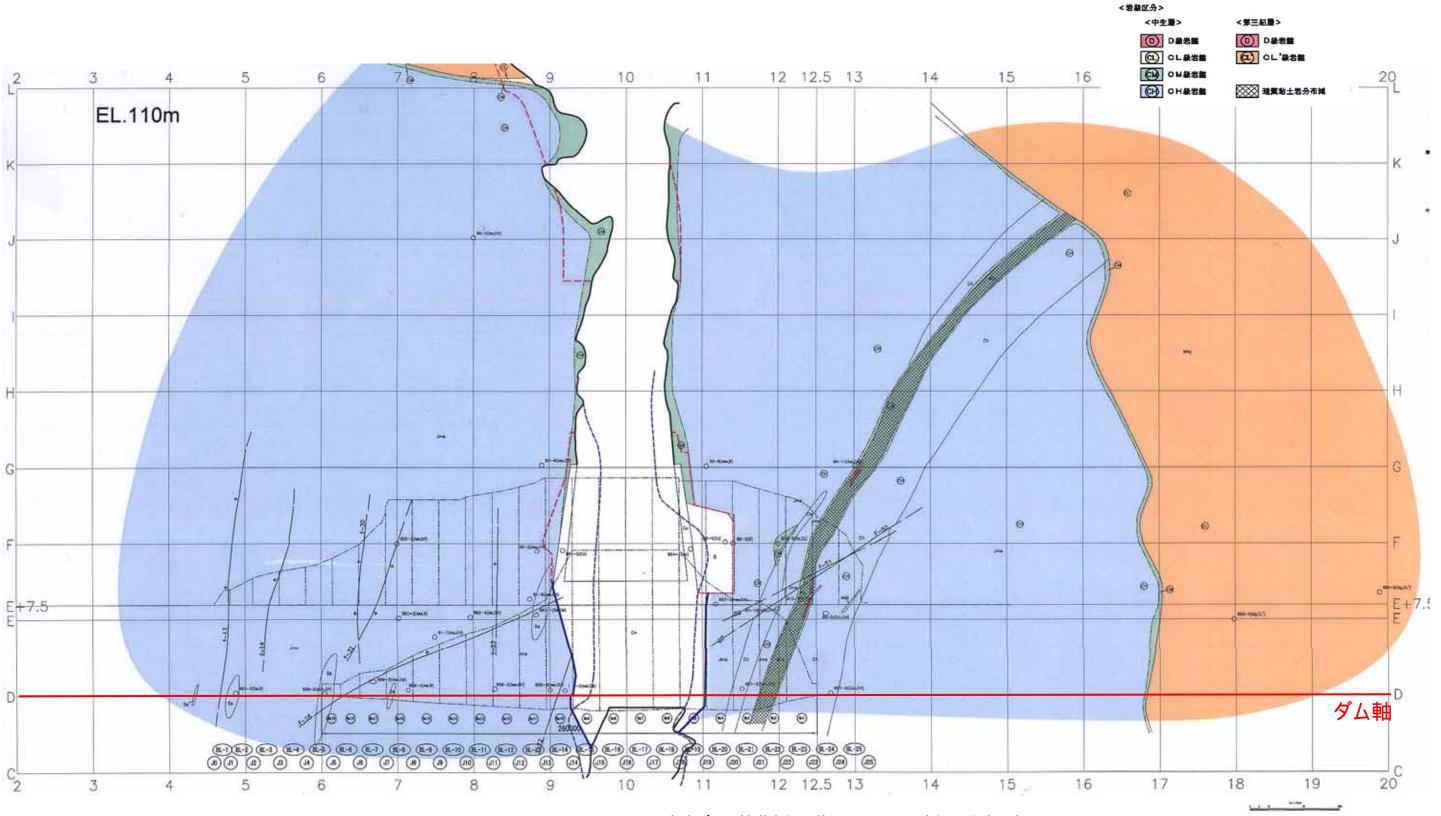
丸山ダムの基礎岩盤の状況(EL.110m 岩級区分水平断面図)
